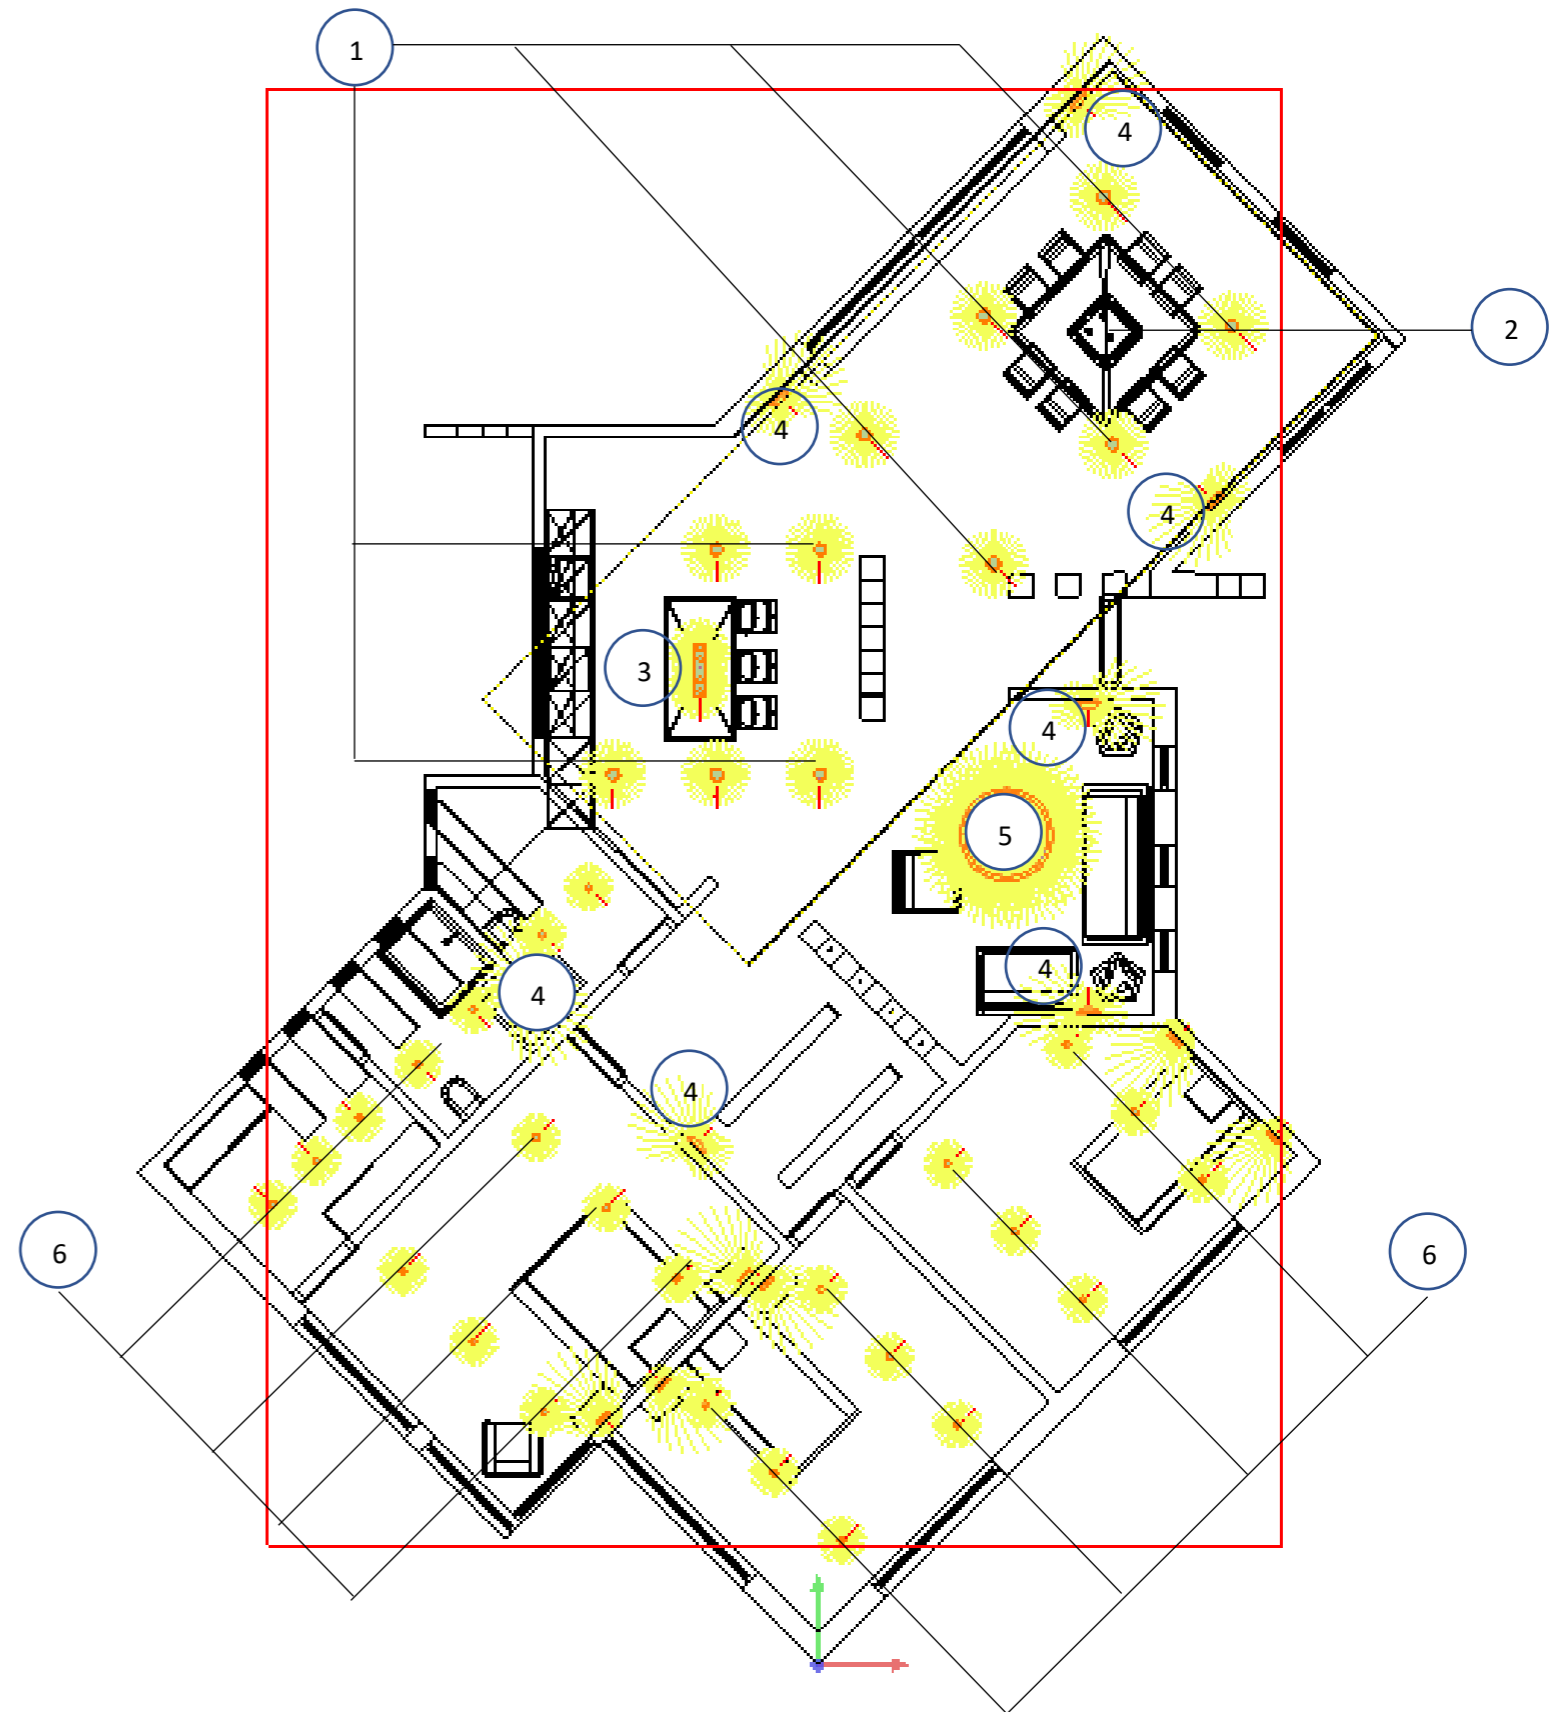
Ubicación de luminarias en planta arquitectónica (DIALUX)
